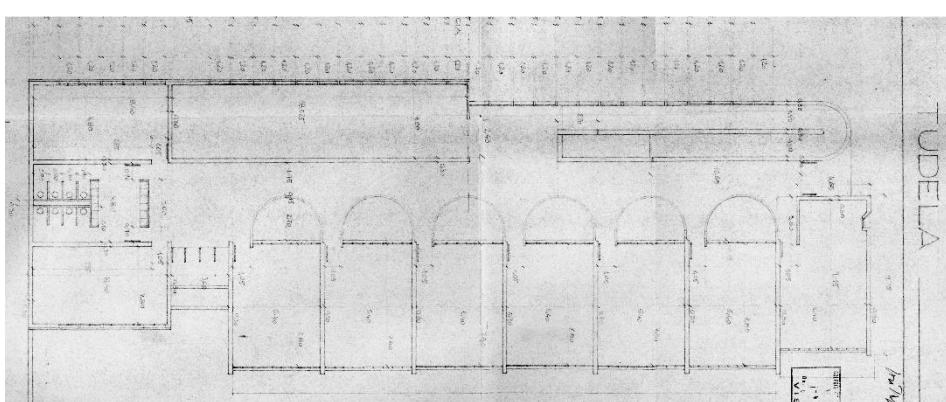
Escuelas Públicas de Tudela. Planta primera. Fotografía 2017
